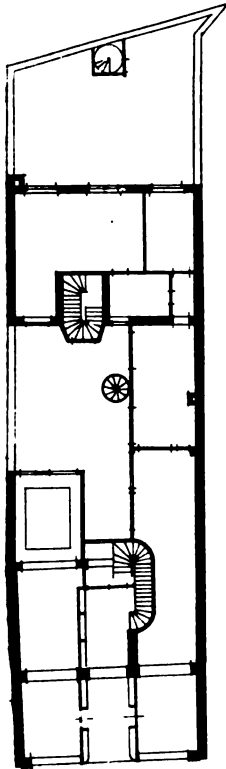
Shadowstrasse 47. Erdgeschoss. 1:500.
